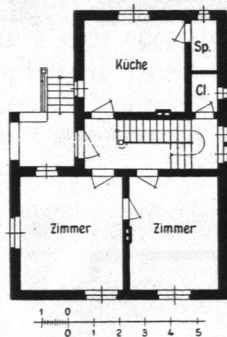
Haltestelle Dhlisdorf, Wohngebäude, Grundriß.
